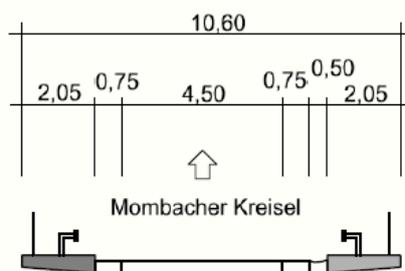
Querschnitt Ausfahrrampe Bingen - Mz-Mombach Bauwerk
